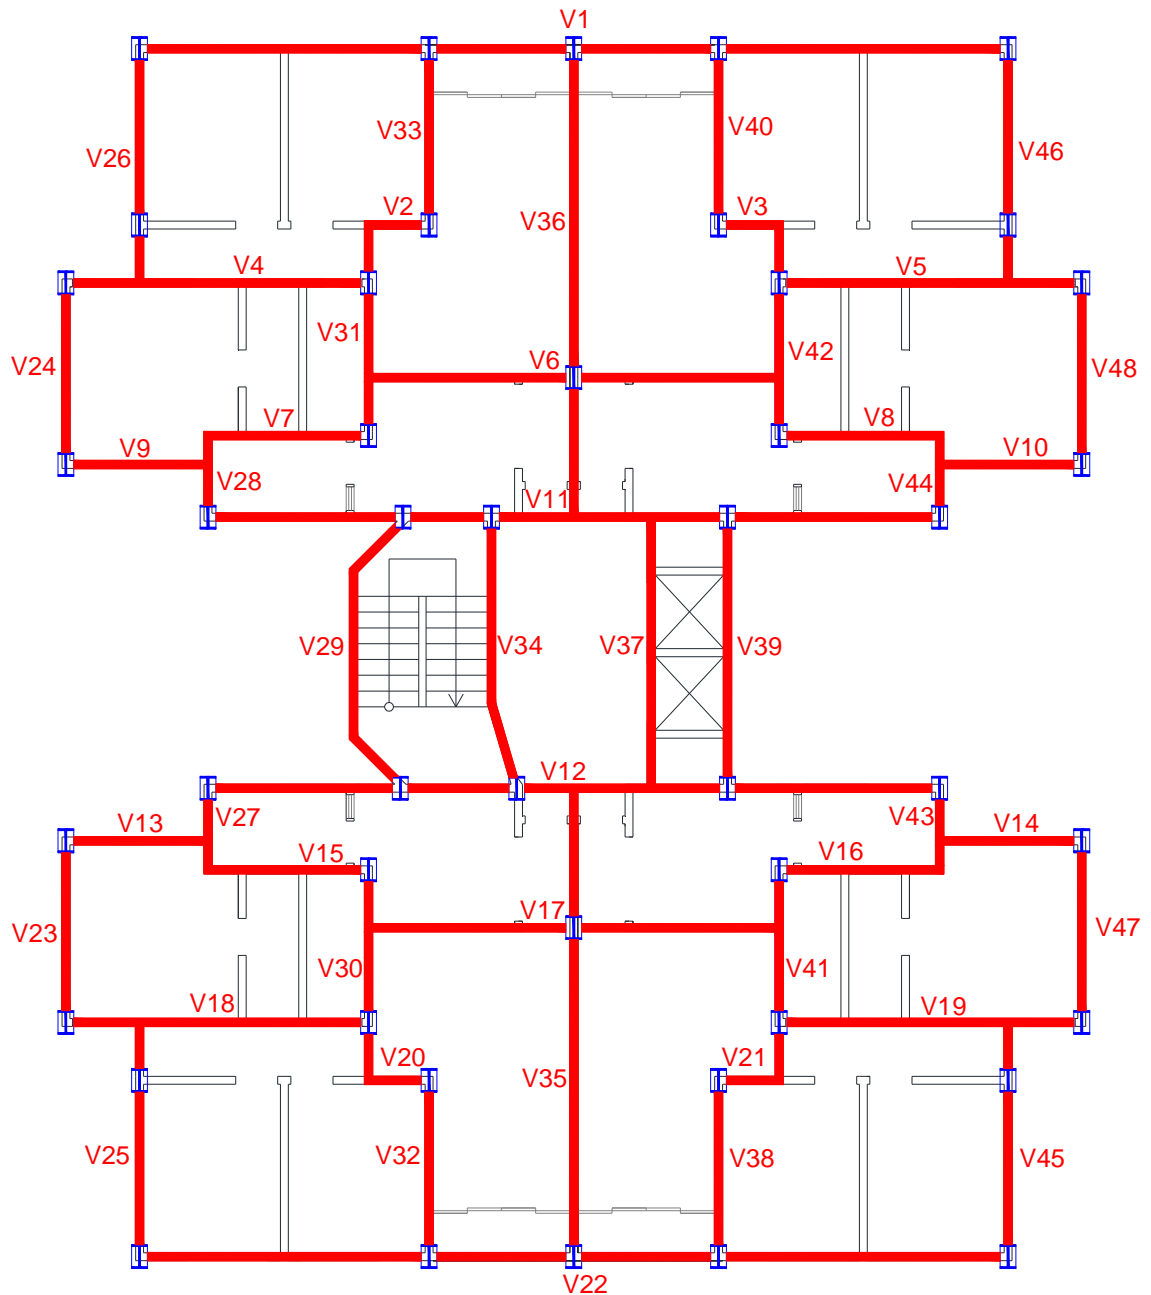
Localização das vigas em aço – Residencial Casemiro Bôscoli.
